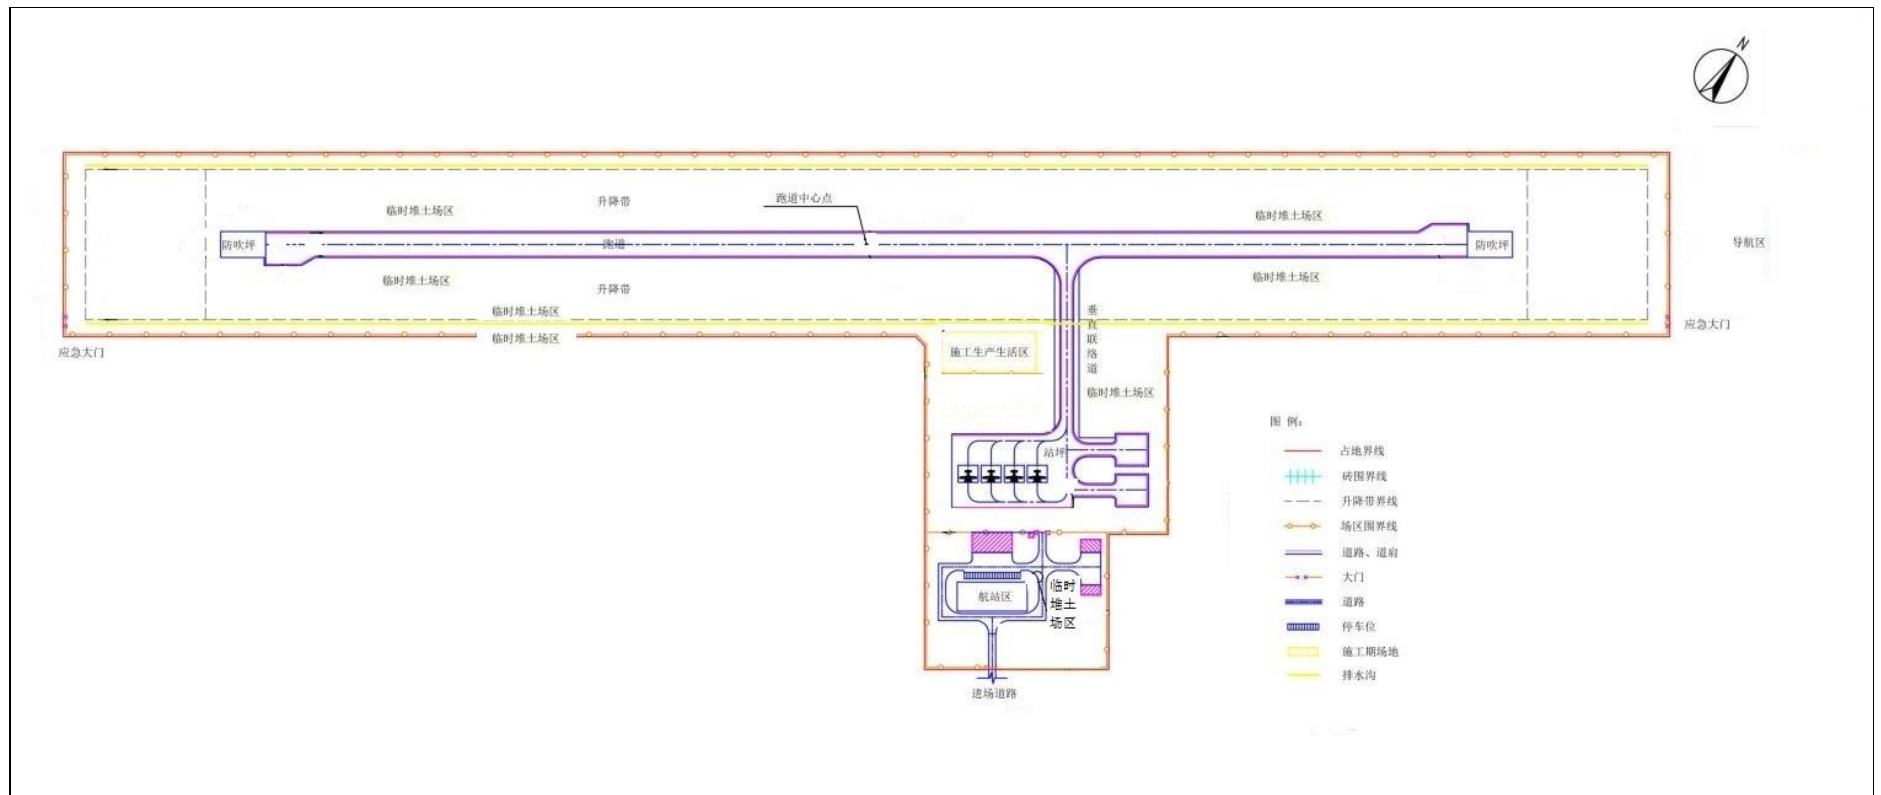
河北沧州中捷通用机场施工期间实际平面布置示意图
